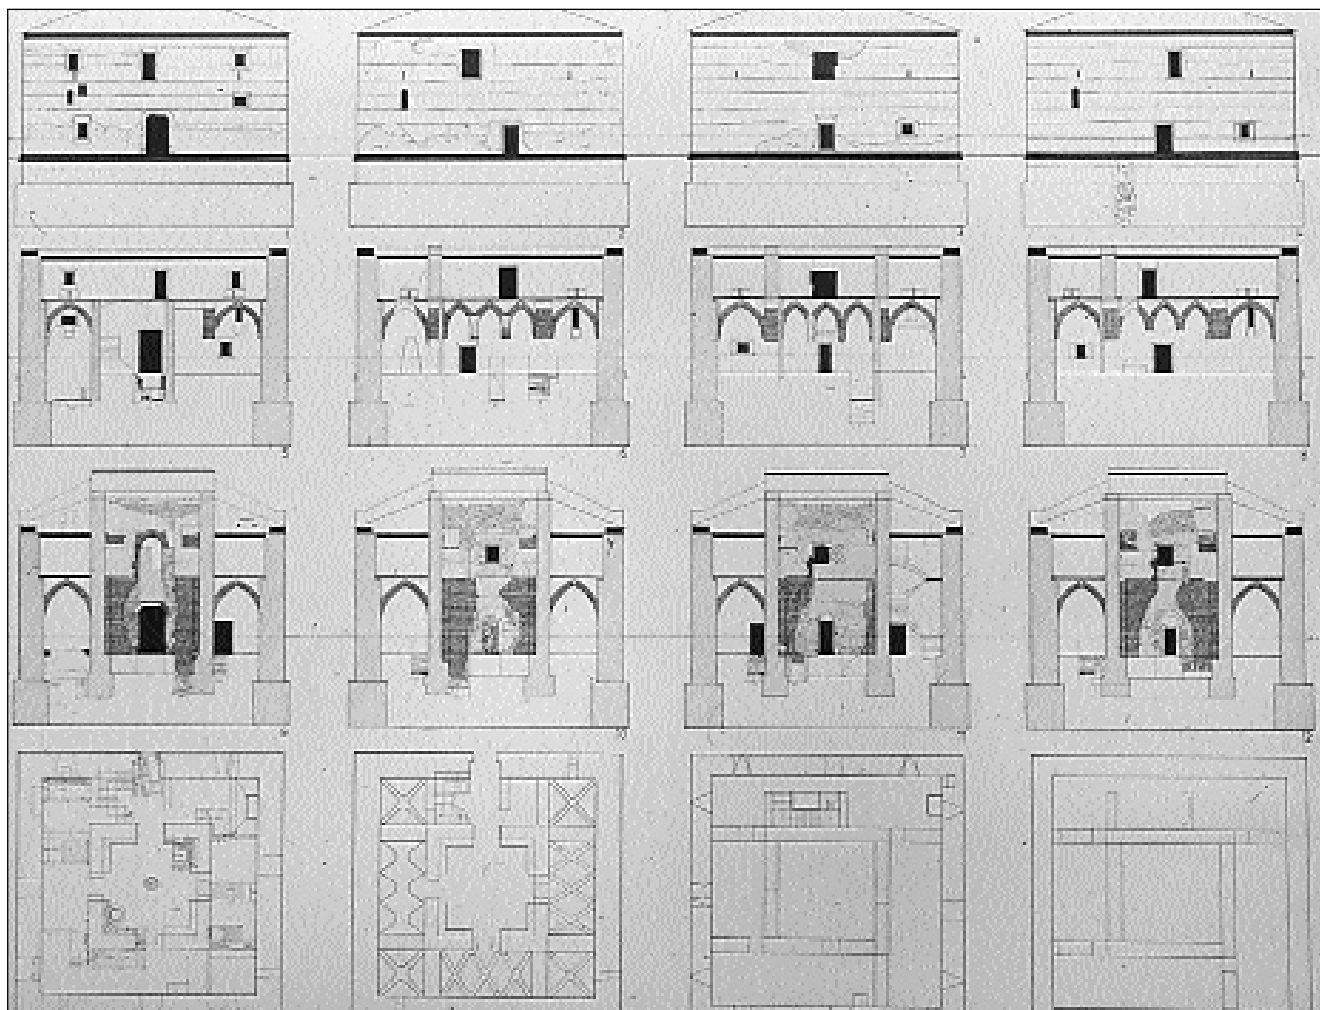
Plano de plantas, alzados y secciones de la Torre Vieja
